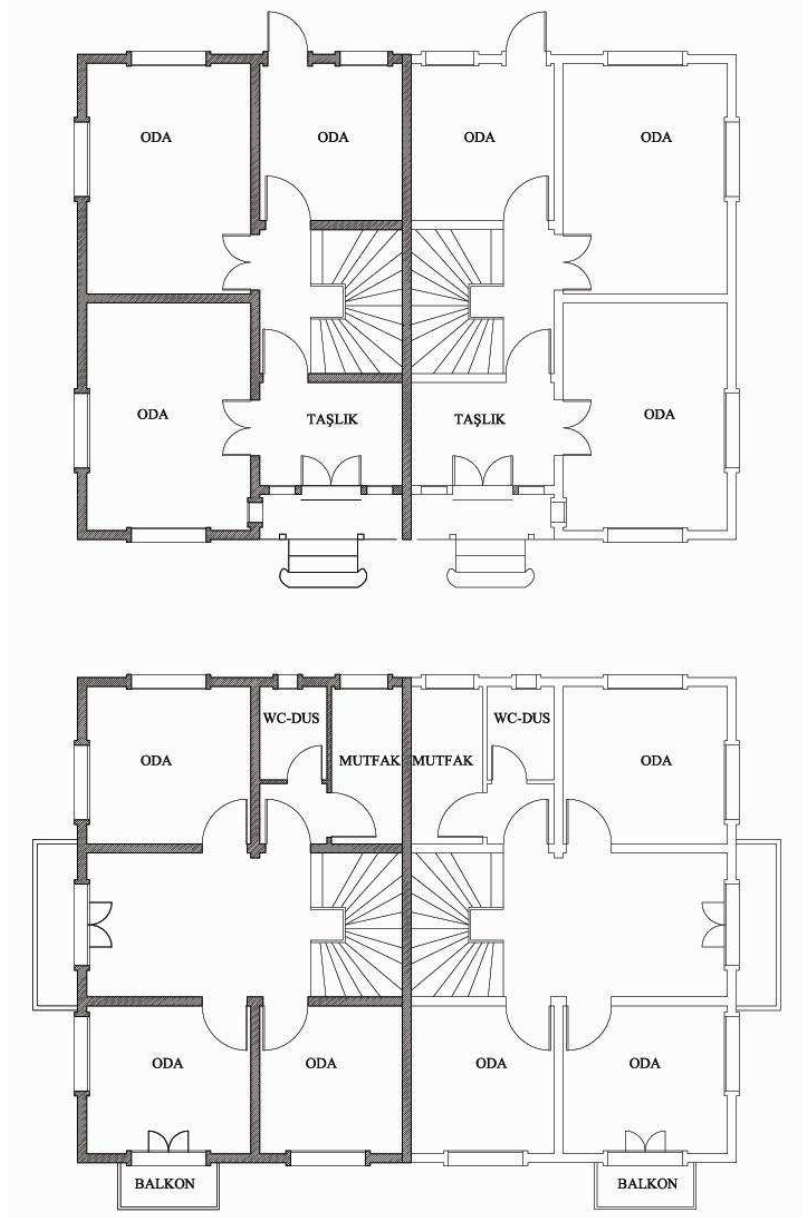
Tekirdağ, Ertuğrul mahallesinde geleneksel Türk evi plan tipine örnek
